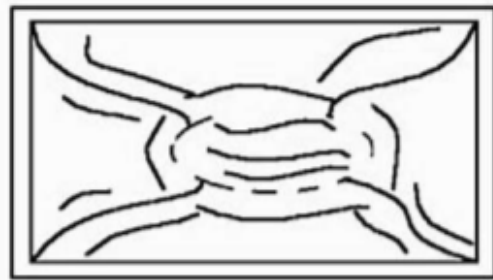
Fissuração por flexão, devida à insuficiência de armadura para os momentos positivos. As fissuras surgem na face inferior
